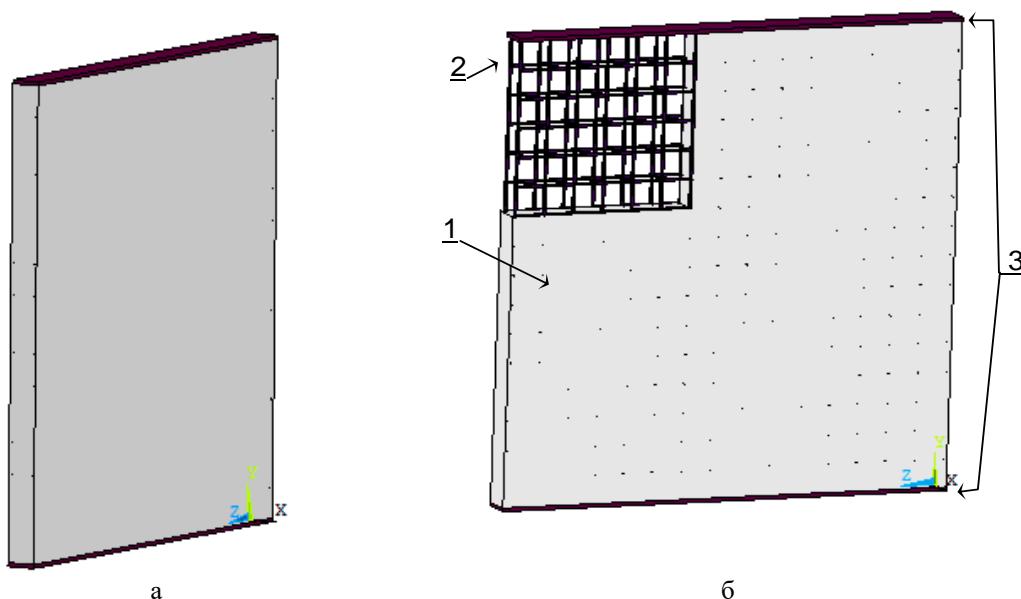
Схема расчетной области железобетонной несущей стены для проведения расчета предела огнестойкости (а - общий вид, который используют для вычислительного эксперимента, б - схема армирования) 1 -бетон, 2 -рабочий арматурный каркас: $d = 16$ мм, 3 -траверсы нагрузочной рамы.
